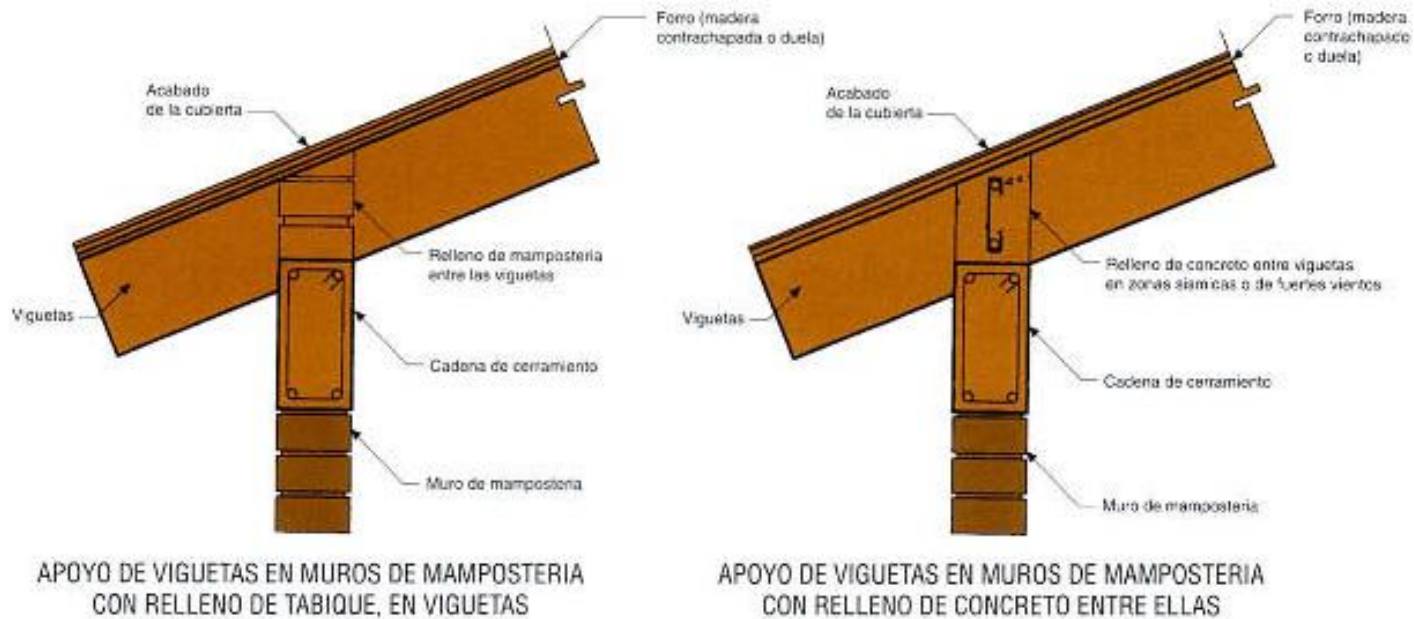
Apoyos de Viguetas en Muros de Mampostería.
